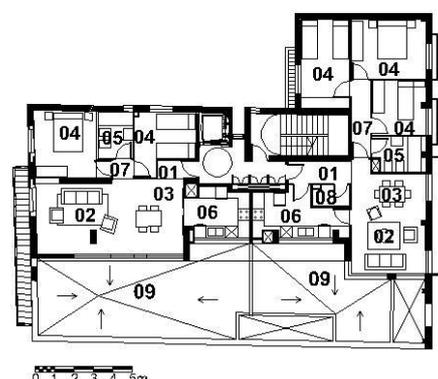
Pavimento 5º da Habitação de Proteção Oficial Giralt el Pellisser
